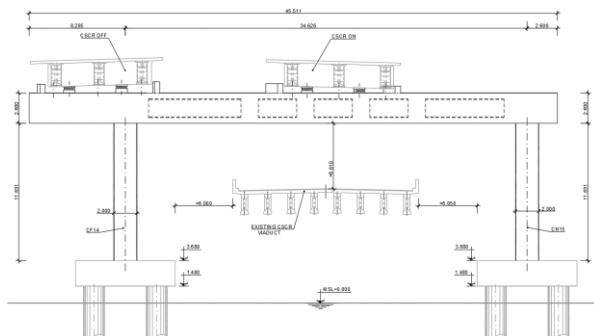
Alzado del pórtico CN15-CF14 del cruce sobre la carretera CSCR
